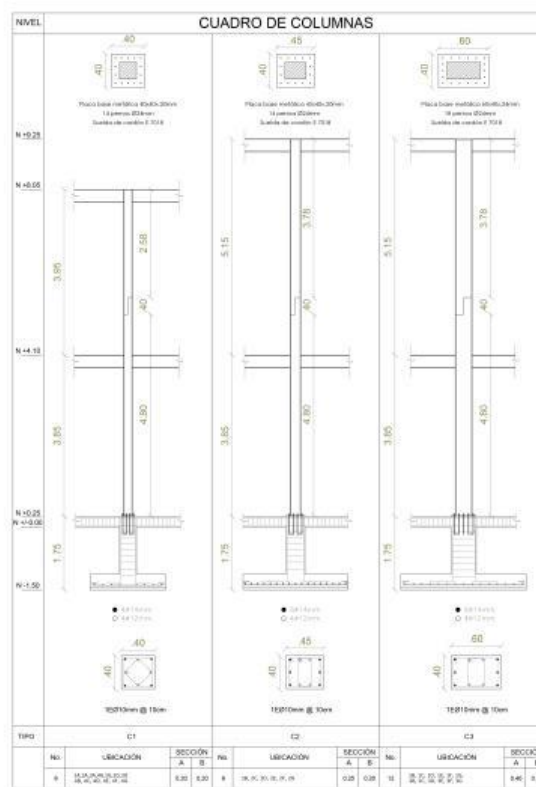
Columnas bloque 1. Fuente: ilustraciones propias
